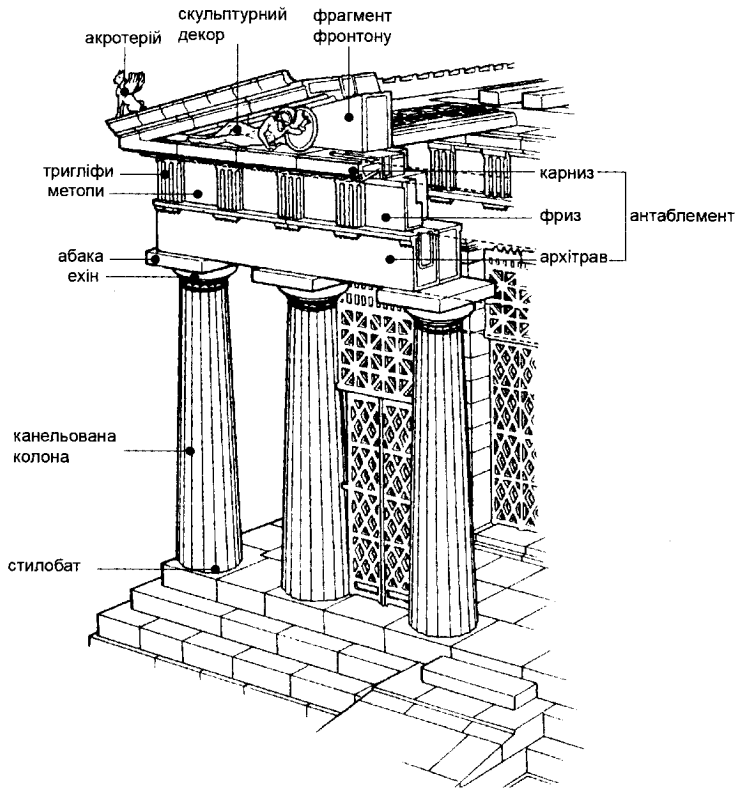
Фрагмент фасаду грецького храму [66]
